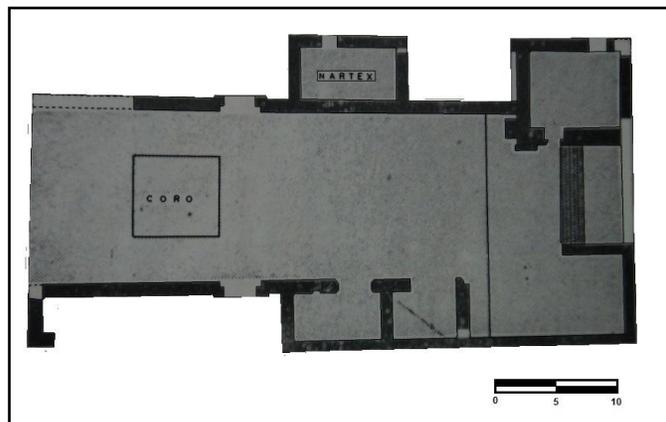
Planta Arquitectónica de la Catedral de León Viejo.
